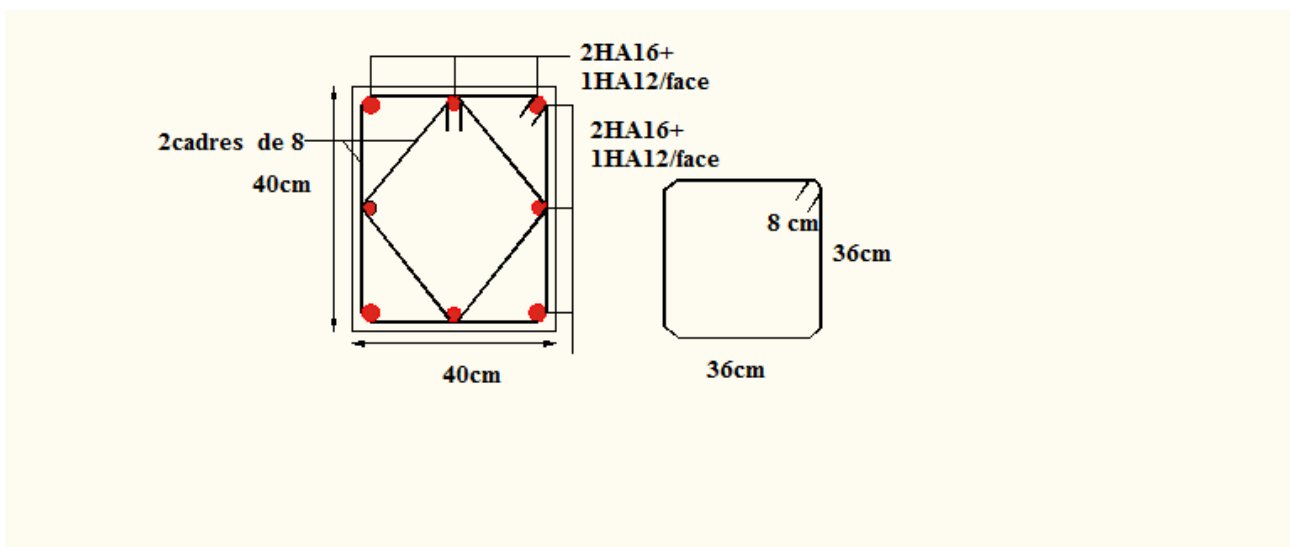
Schéma de ferrailage des poteaux de 2^{ème} niveau duplexe.
